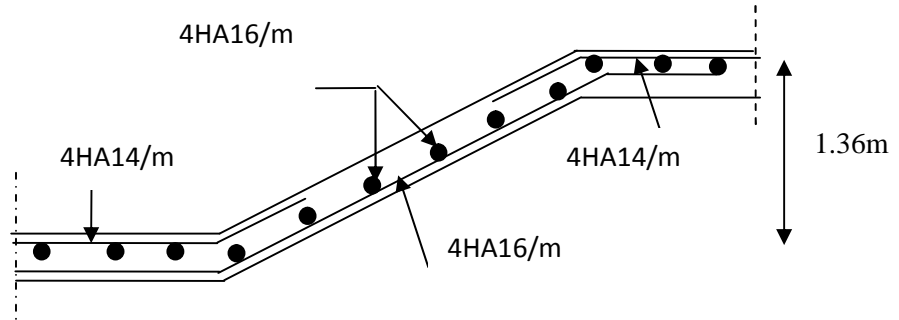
Schéma de ferrailage de la volée 1d'escalier RDC avec cage d'ascenseur
